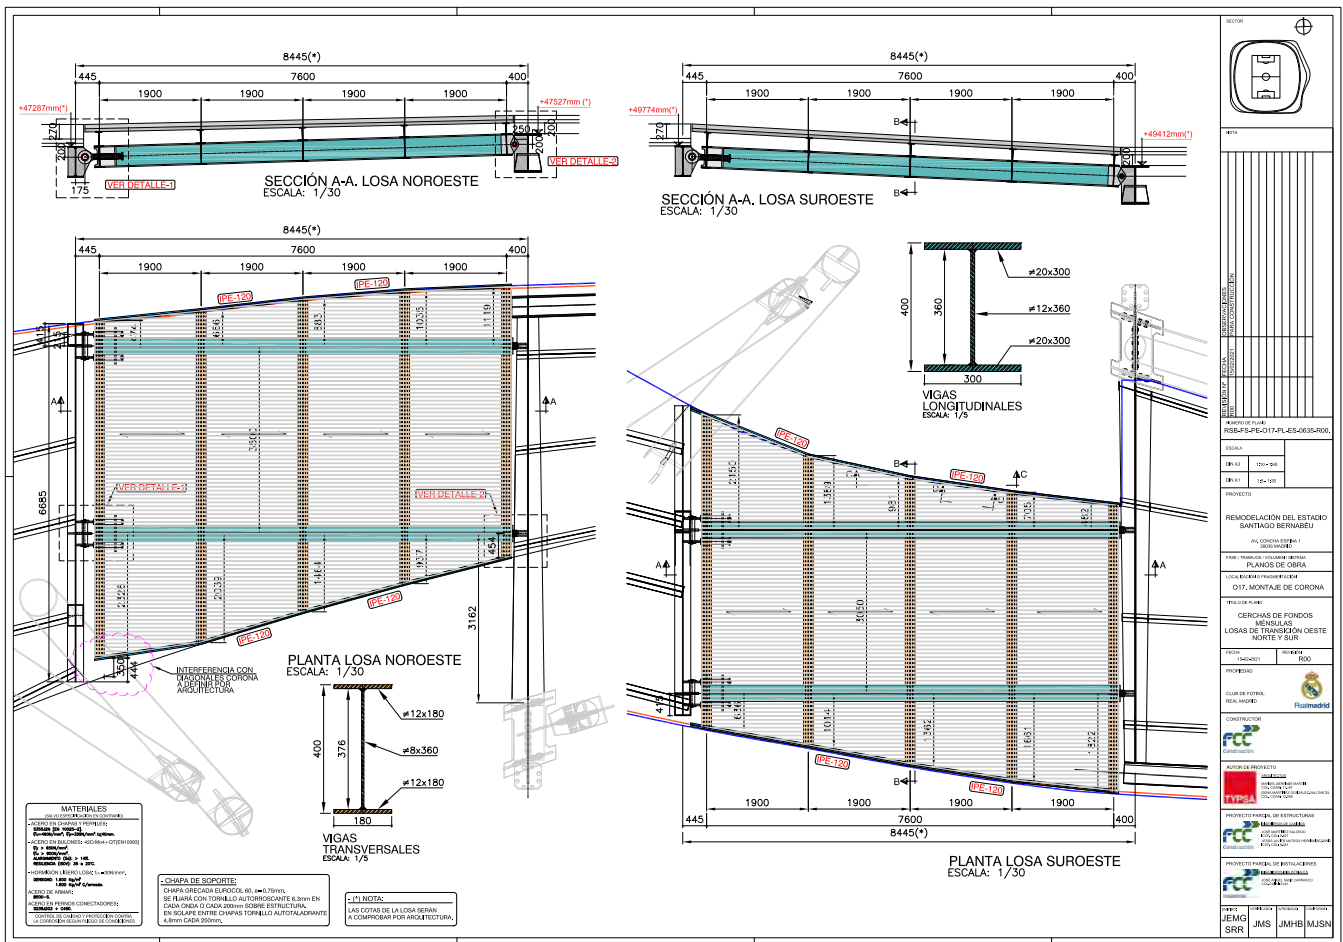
Plano de proyecto con geometría de las losas de transición en las esquinas noroeste (izquierda) y suroeste (derecha).
